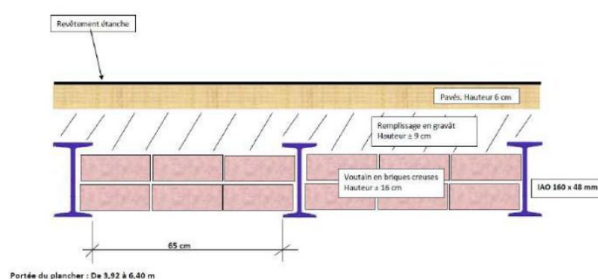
Détail constructif (hypothèse) de la dalle plancher rez-de-chaussée
